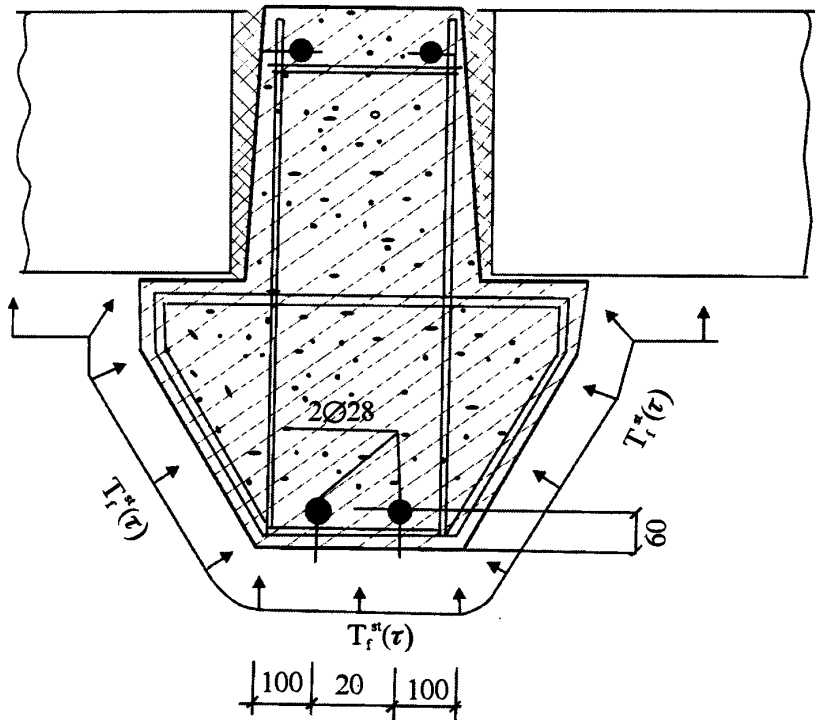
Поперечное сечение железобетонного ригеля и принятая схема воздействия пожара на него.
